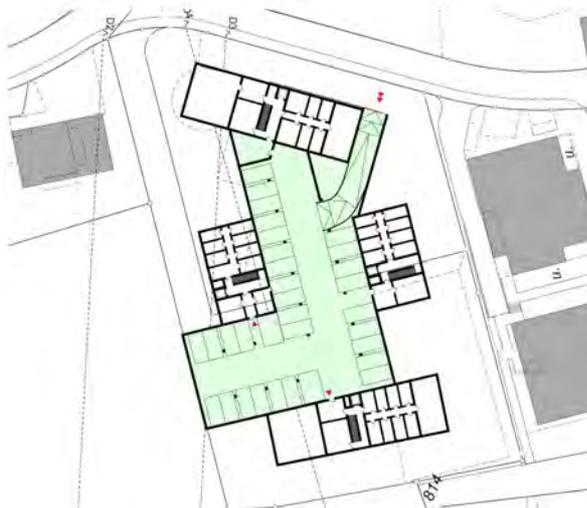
, Schema AEH mit Zufahrt ab Zimmerrainstrasse
